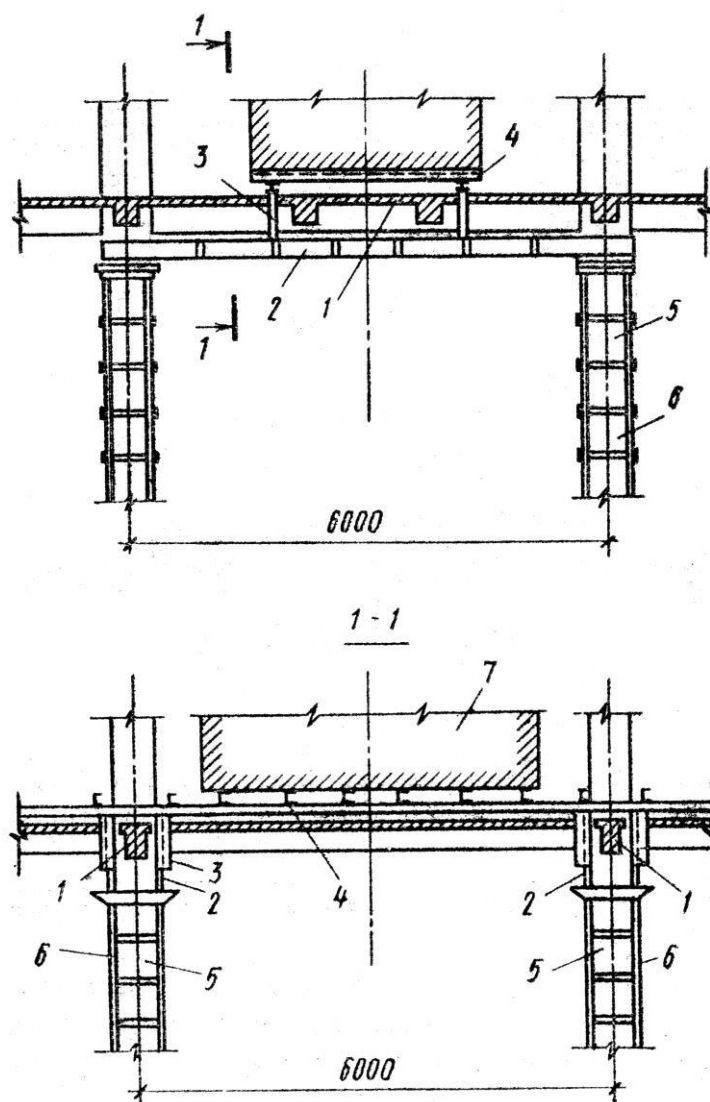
Разгрузка монолитной железобетонной плиты ребристой железобетонной плитой:
